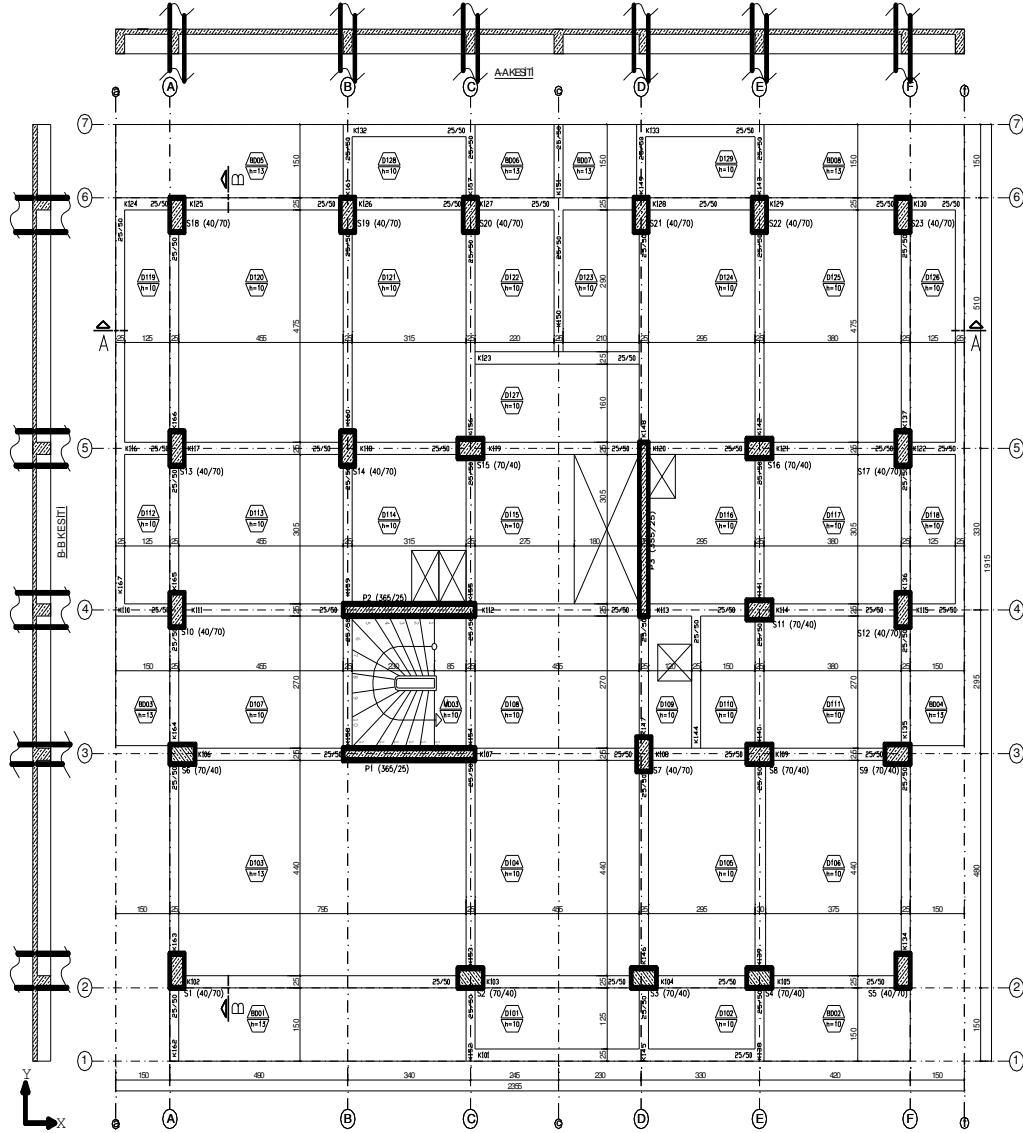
Örnek olarak seçilen planda simetrik sekiz katlı betonarme yapıya (BY1-8) ait kalıp planı
